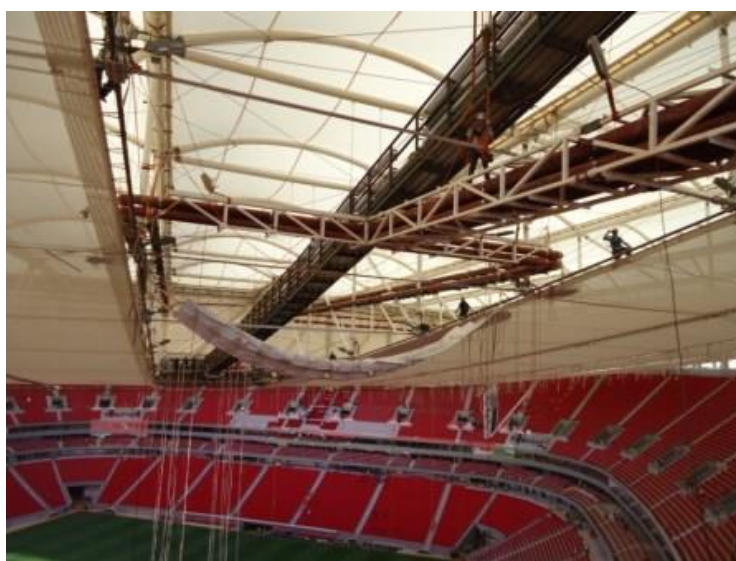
Ponte de drenagem em “T”, projetado para o caminhamento de 6 tubos DN 250mm.
